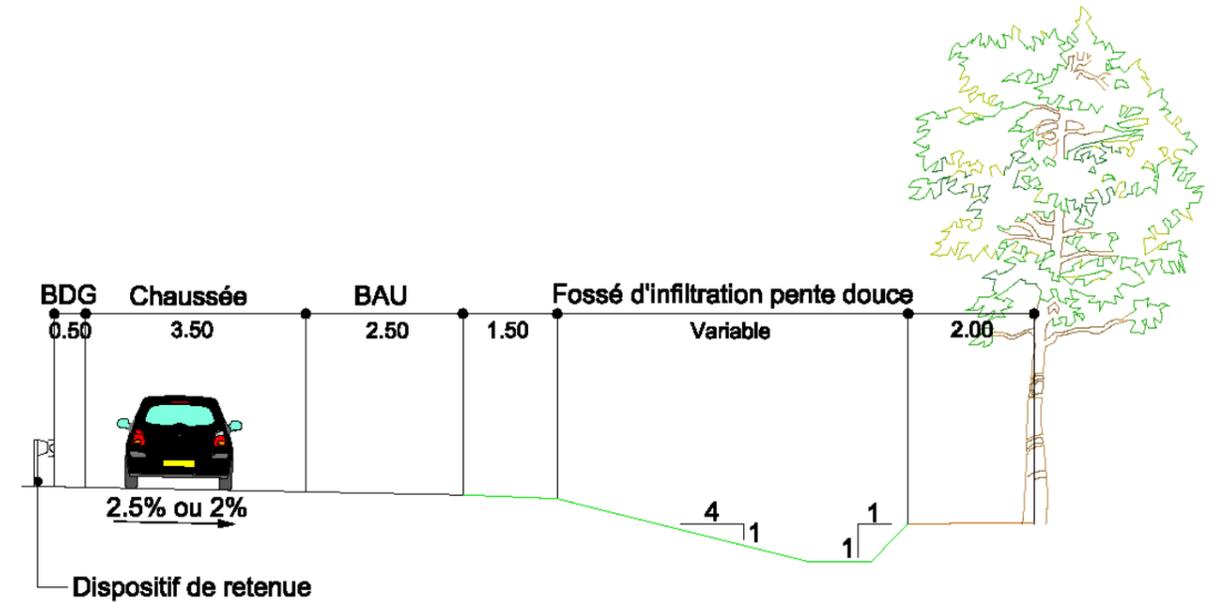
Profil en travers type de la bretelle de sortie de la RN 12
